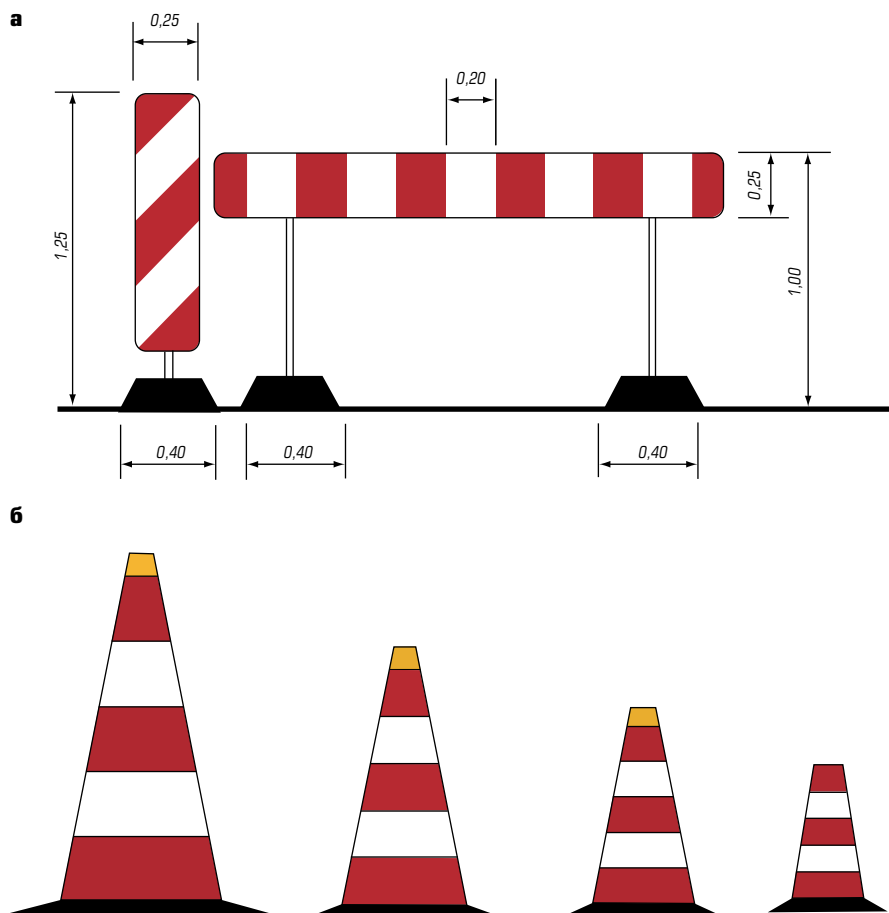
Заградительные устройства по нормам Германии: а — пластины и барьеры; б — направляющие конусы
